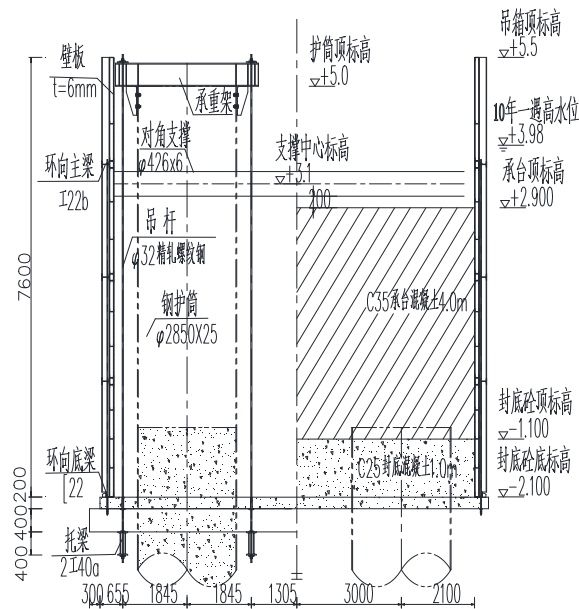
10.5 m × 10.5 m × 4 m 钢吊箱结构立面布置图 (mm)
